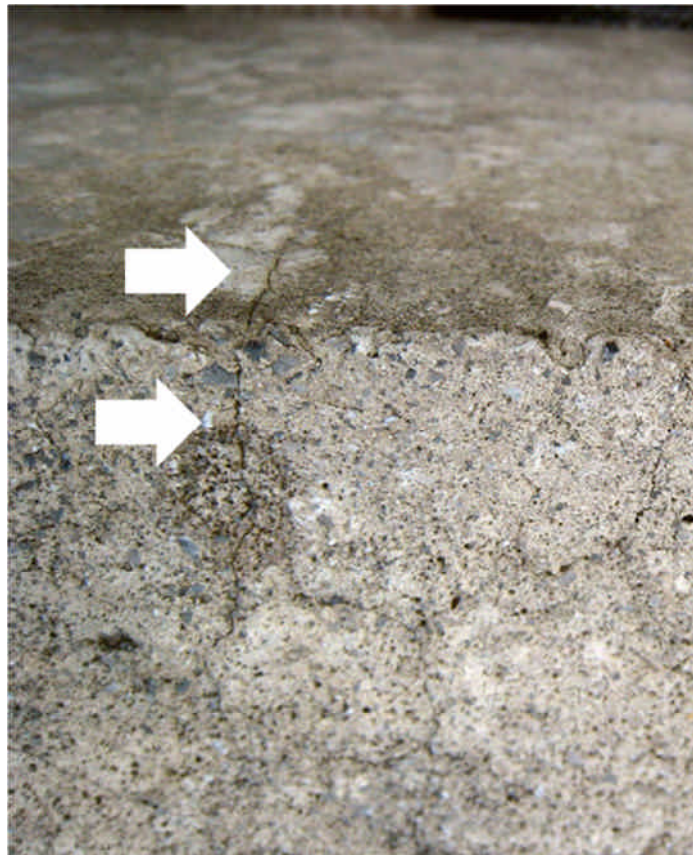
角部限定ひび割れ (c1) の例
